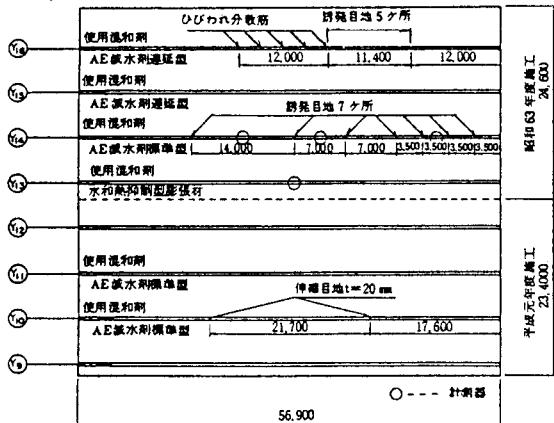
ひびわれ幅制御対策配置計画平面図
